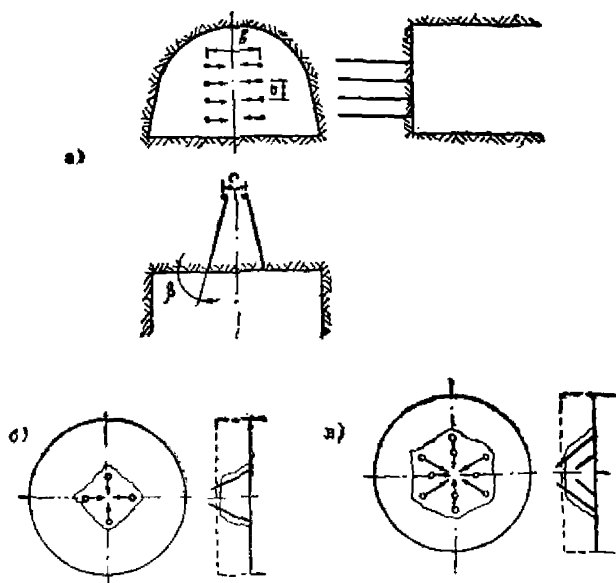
Схема выполнения вертикального клинового и пирамидального врубов:
